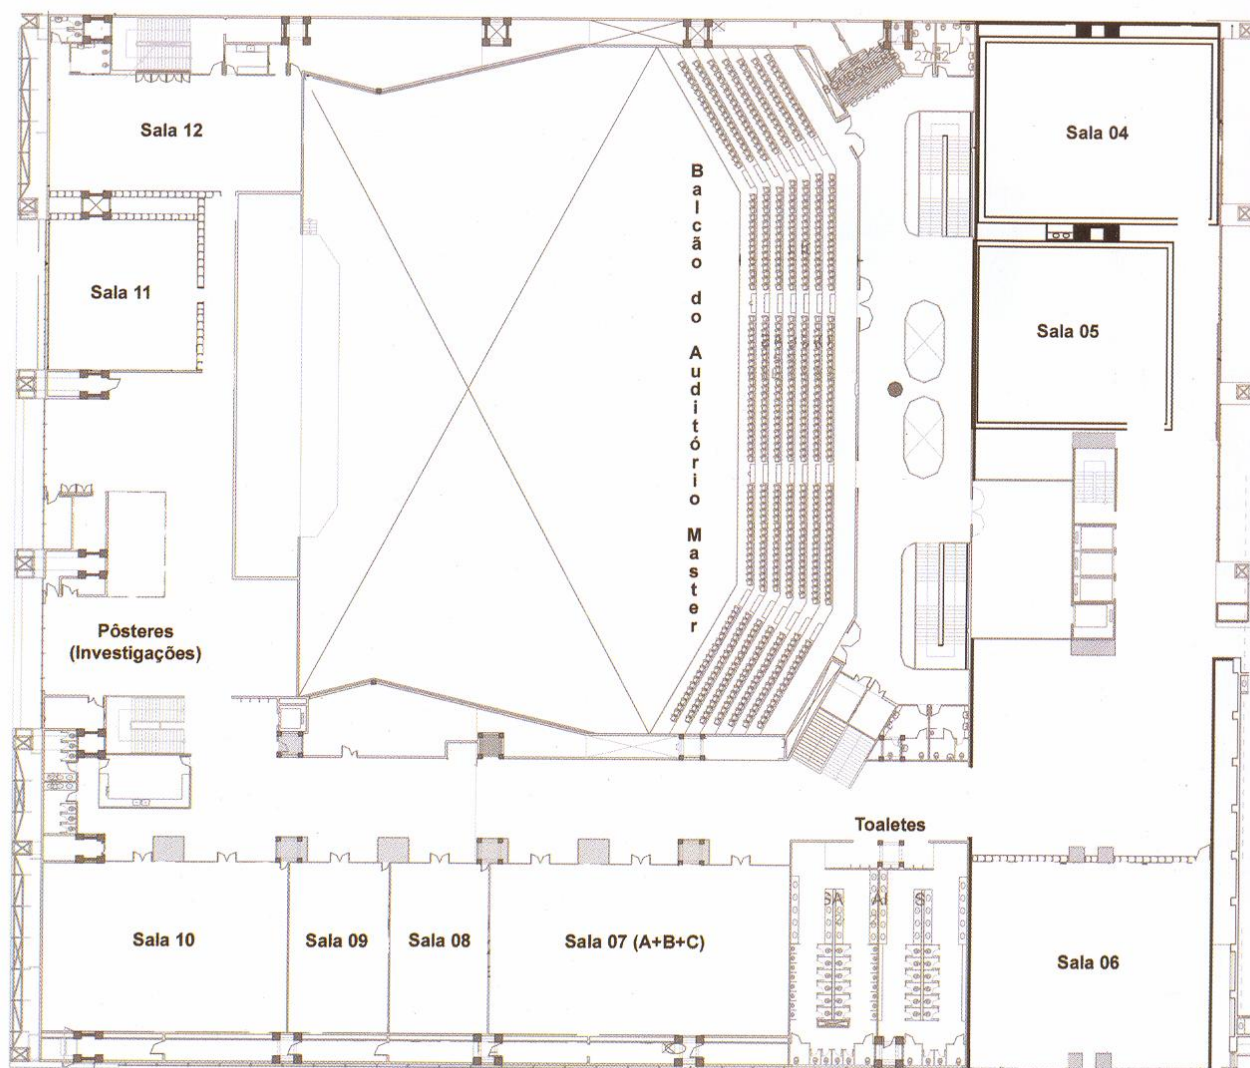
Planta Baixa Térreo - Novo Centro de Convenções
